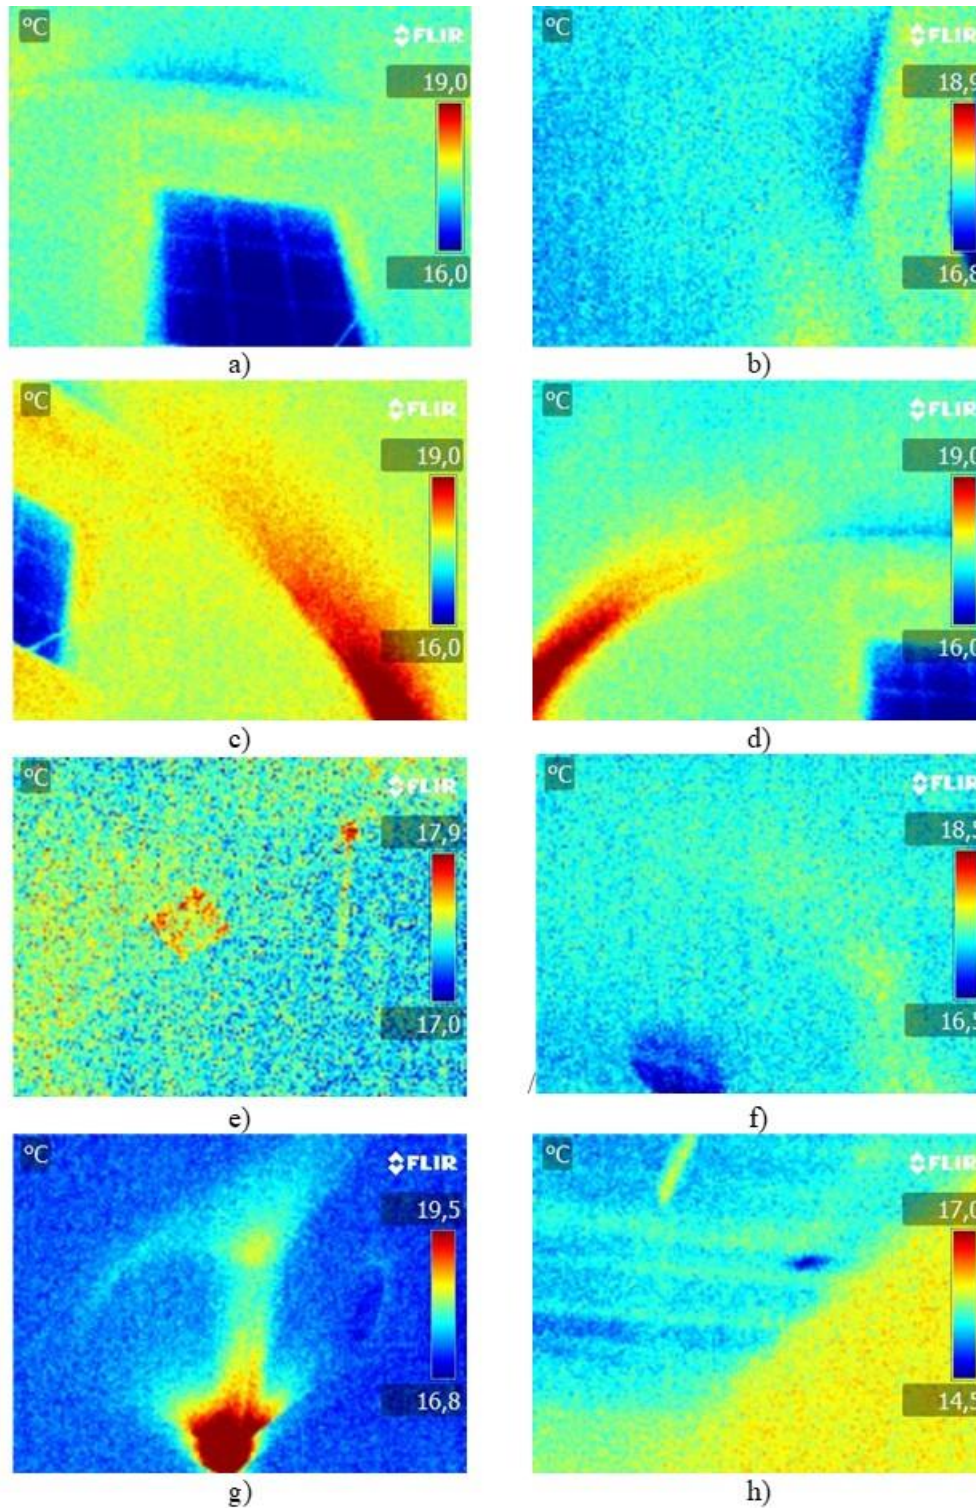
Termografia da sala sob a cobertura 2: a) janela e área da laje, b) vista inferior da cobertura, c) vista da conexão da parede lateral da laje, d) vista da conexão da parede lateral da laje, e) área central da cobertura, f) vista da parede divisória traseira, g) vista da conexão da parede lateral e da parede traseira, h) vazamento na área externa.
